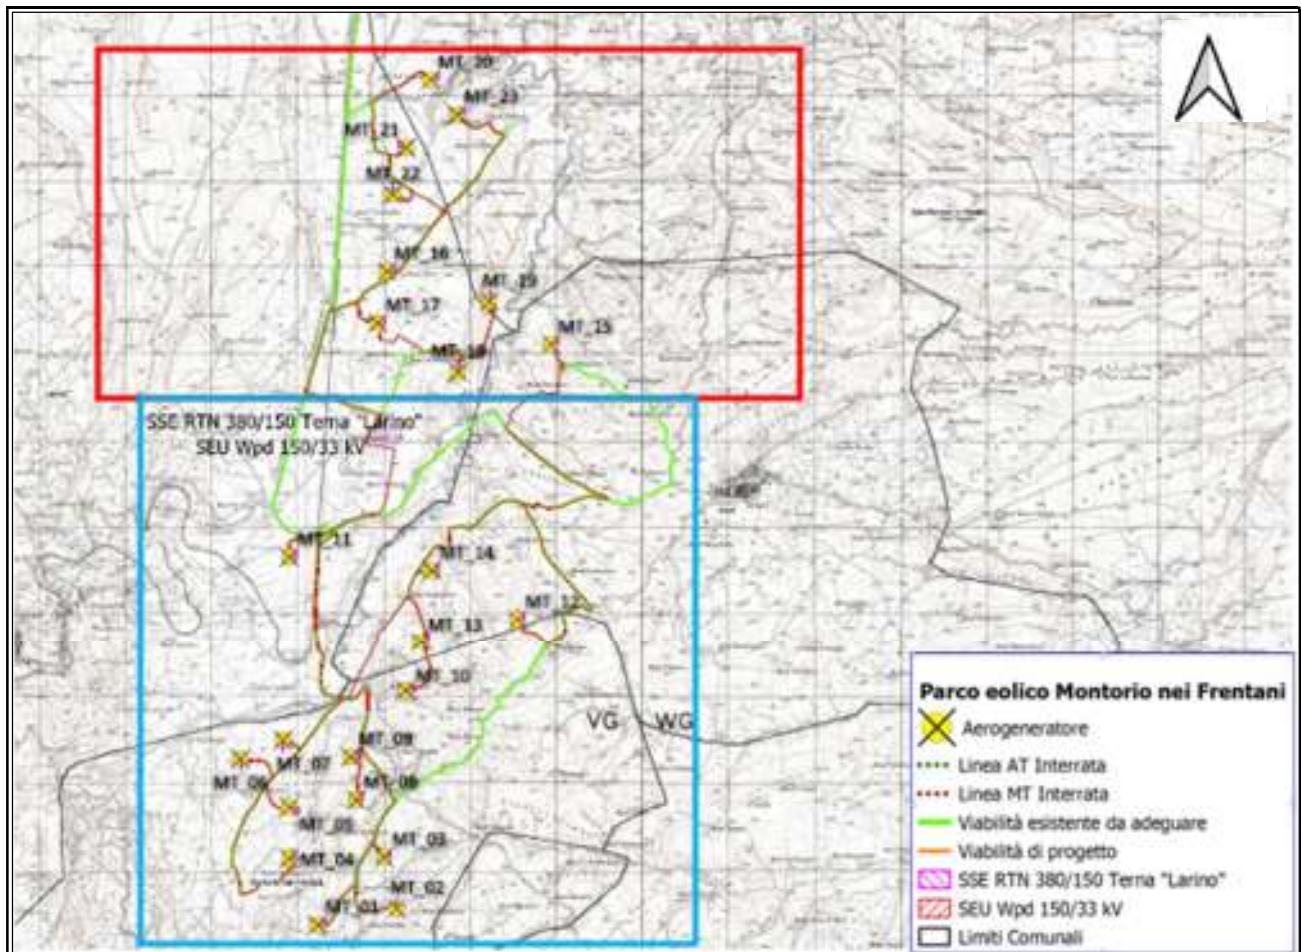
Layout d'impianto suddiviso in zone su IgM: Zona 1 (rettangolo rosso) e Zona 2 (rettangolo azzurro)
